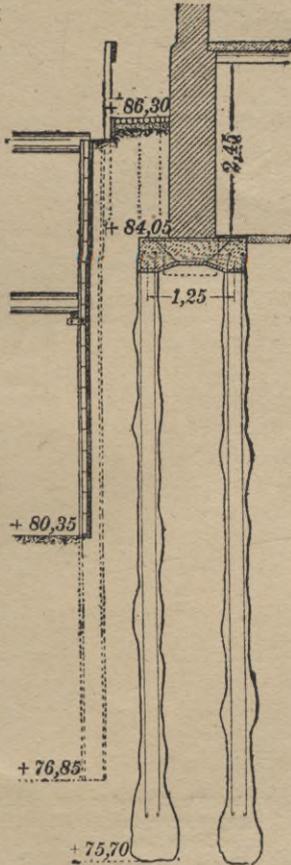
Unterfangen einer Frontmauer mit Eisenbetonbalken auf einbetonierten Pfählen.
